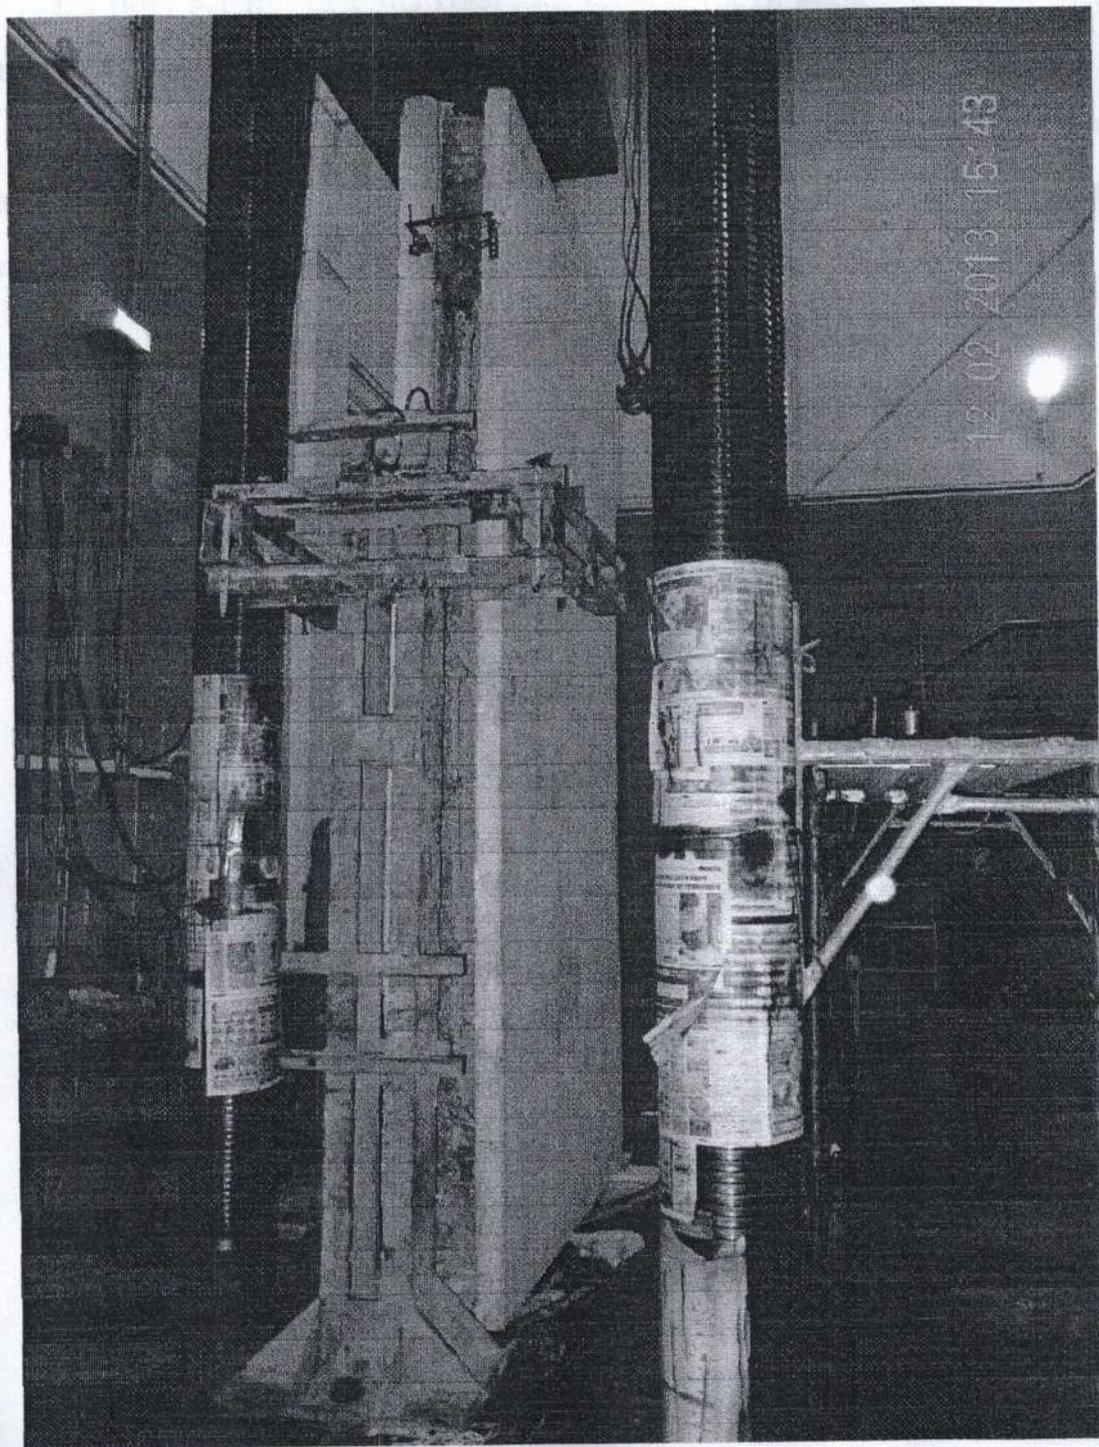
Общий вид опытного образца, установленного в пресс.
